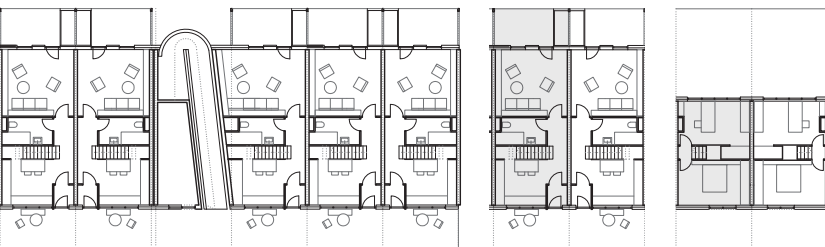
(fuente: STEINER, Volker. *Grundrisse un Lagepläne, Mehrfamilienhäuser, Band II*. Editado por Fachbereich Architektur. p.133)
